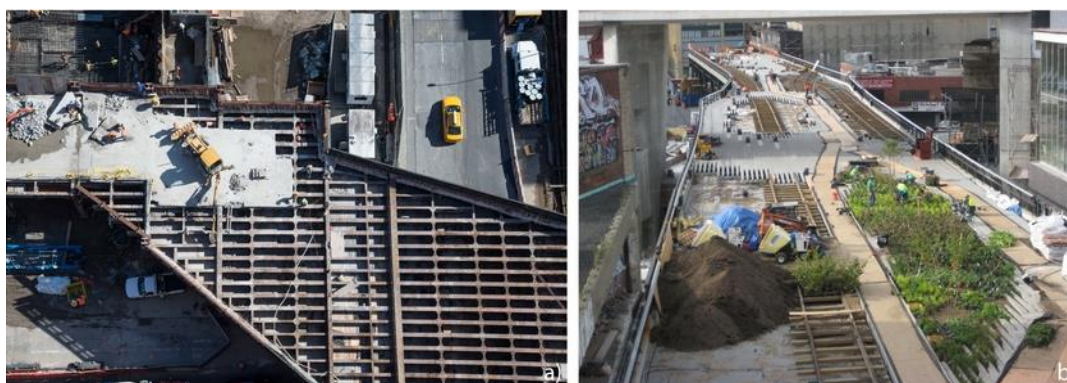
a) cofragem sobre estrutura metálica pré-existente; b) aplicação de placas de betão pré-fabricado e carris sobre camada de regulação.
